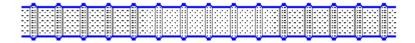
Varillas corrugada utilizada en armadura longitudinal.
